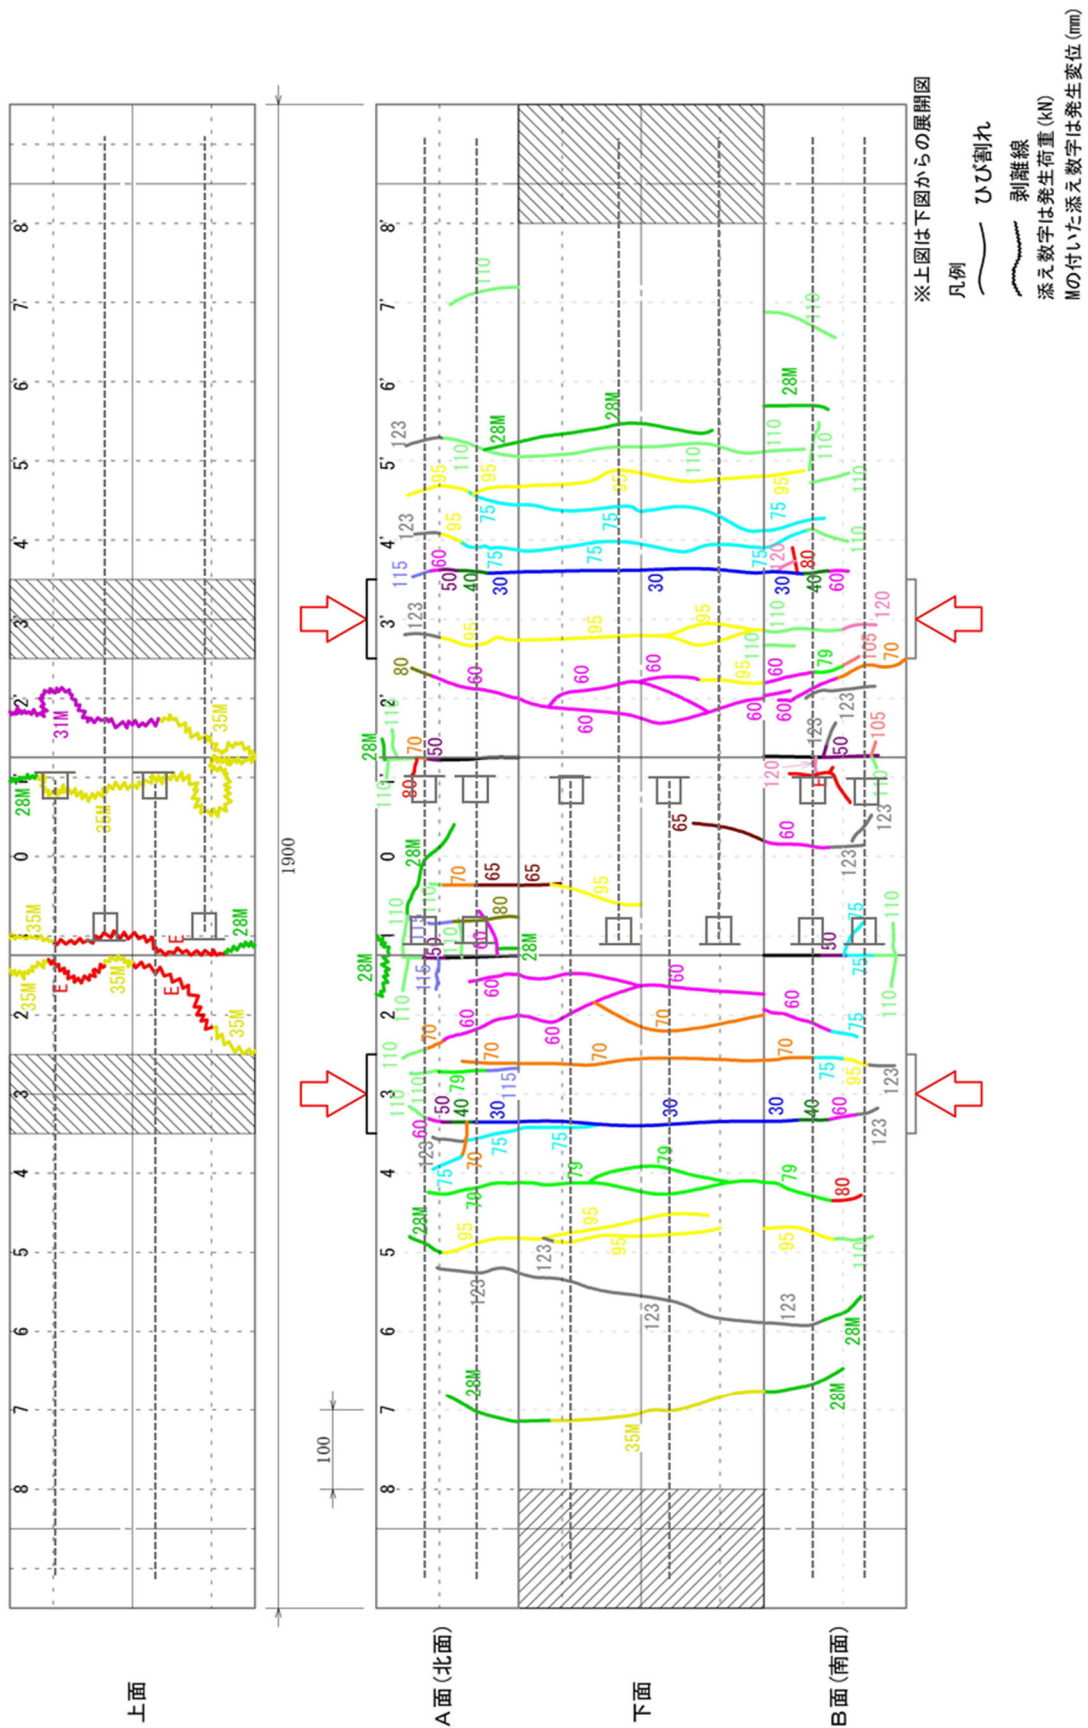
ひび割れ図 (供試体 S1-3)
